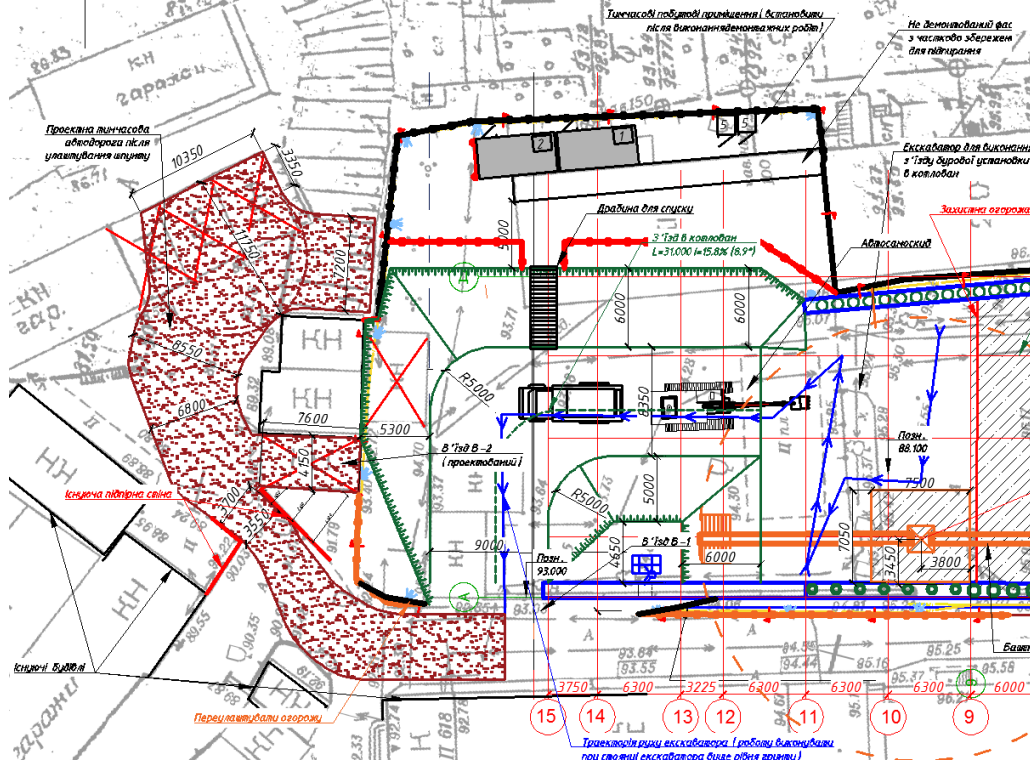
Фрагмент будівельного генерального плану. Організація в'їзду В-2
